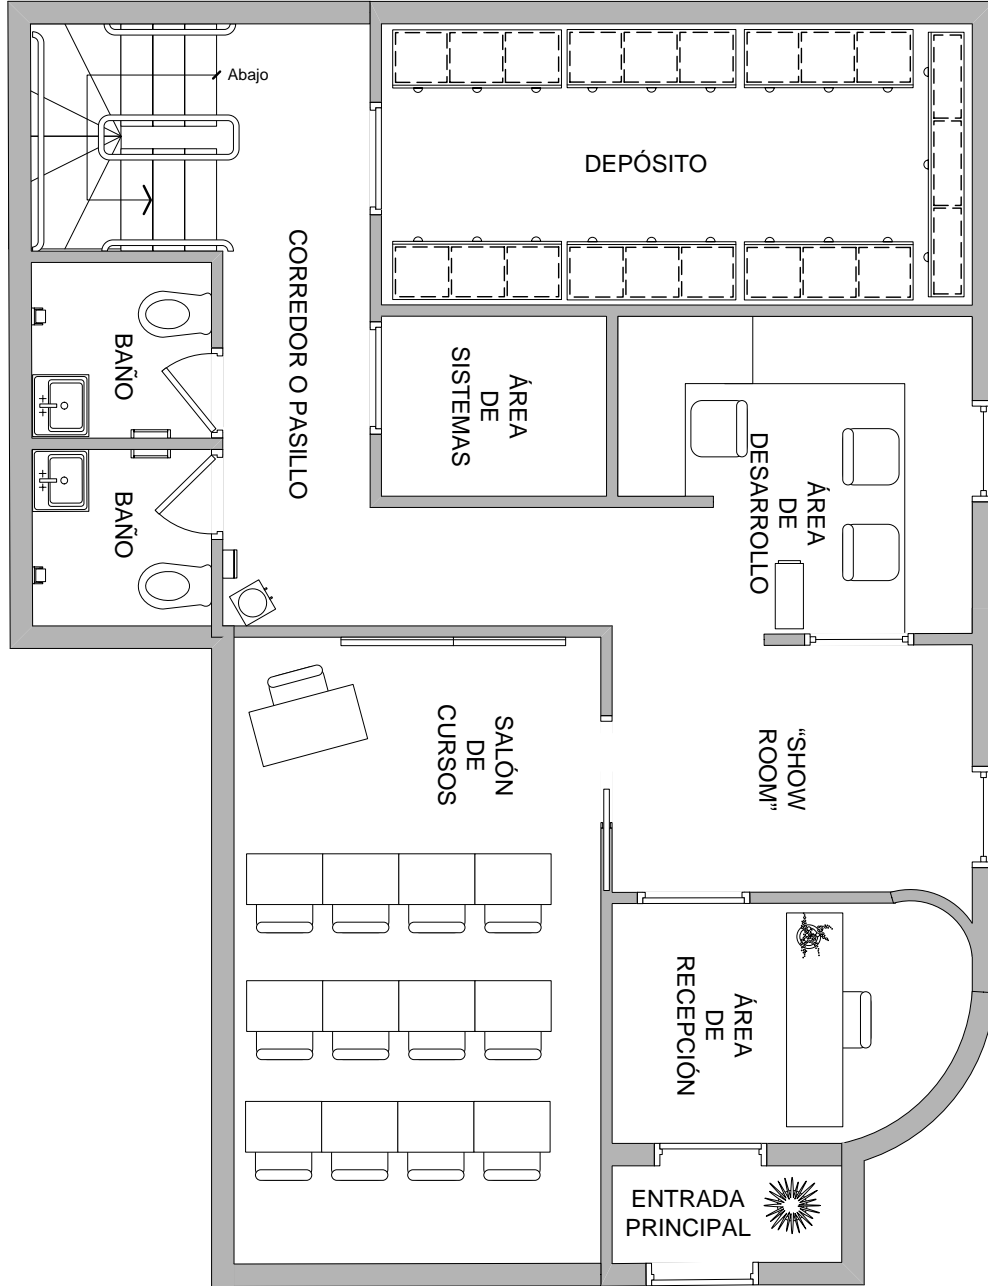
Planta Baja de la Sede Principal de Intrave C.A.
